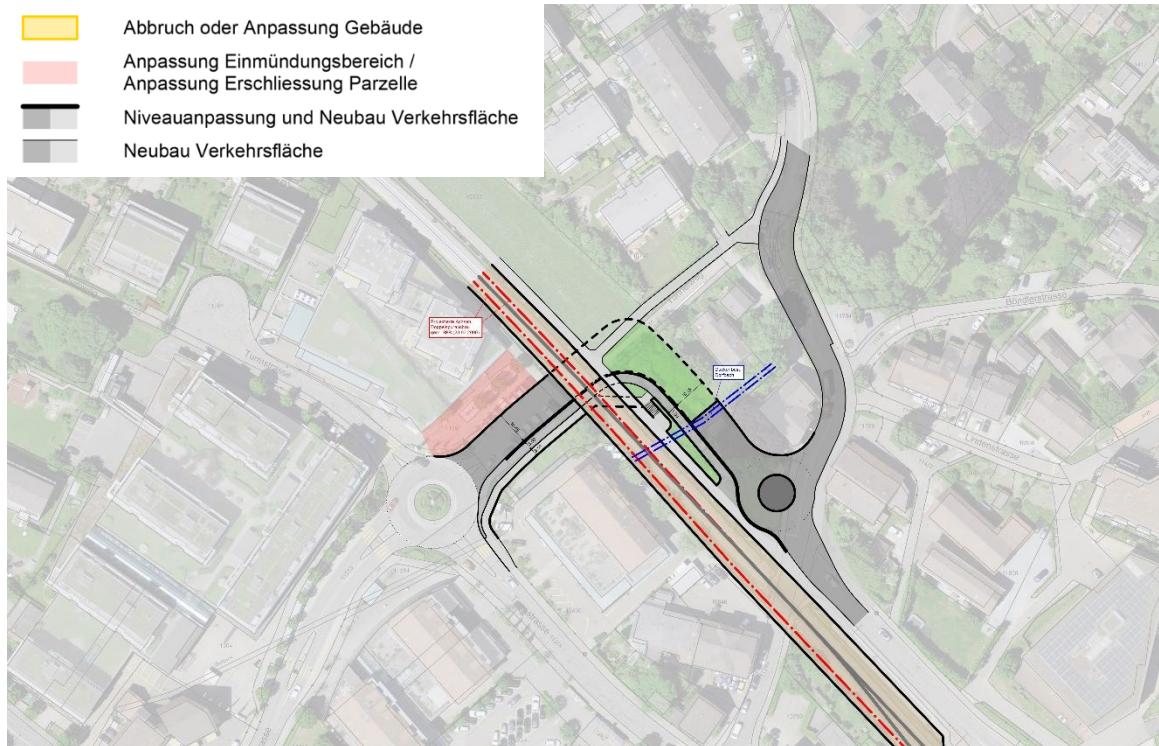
Schemaplan Unterführung Tunnelstrasse Variante "T20"
